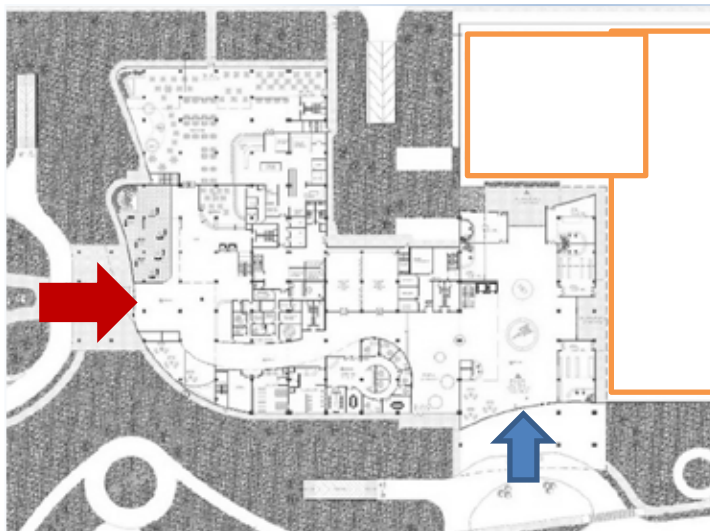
Planta Baja +0.30 Autora: Cáceres (2017).
